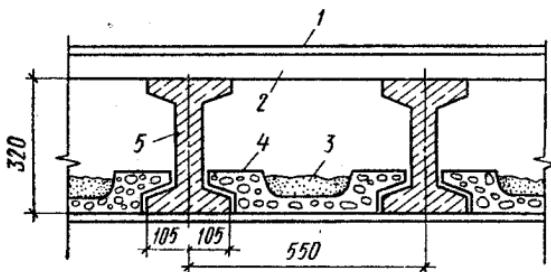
Конструкции для замены перекрытий с железобетонными прогонами швеллерного типа:
